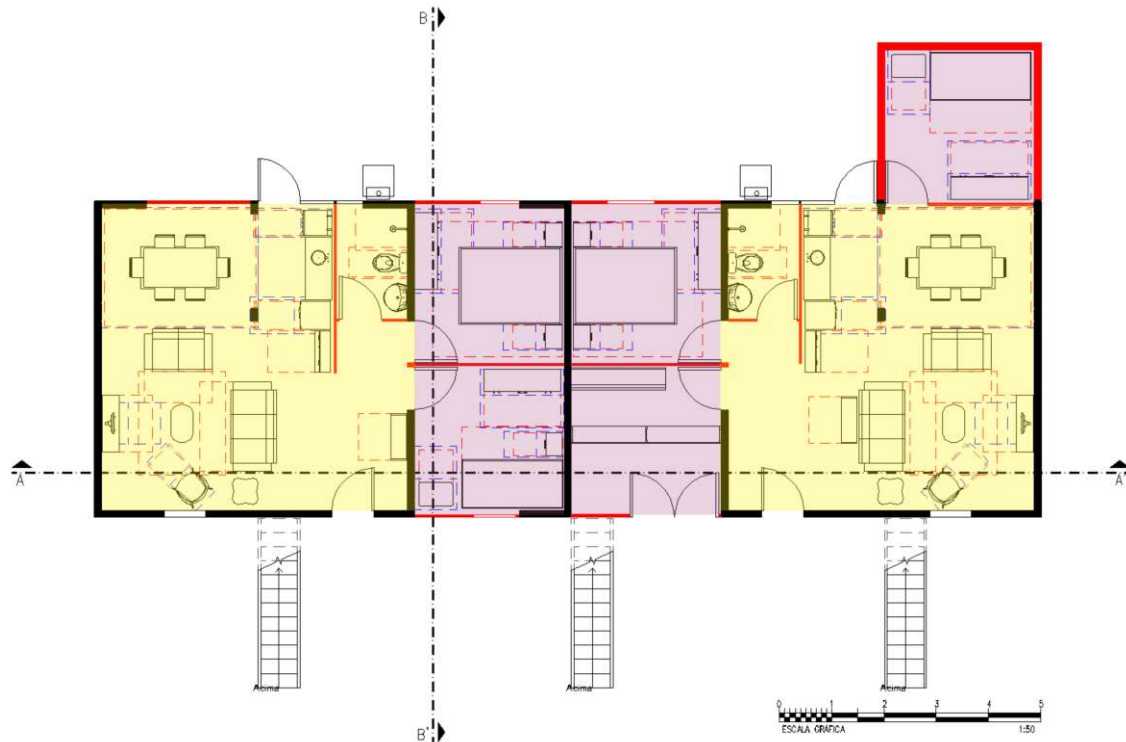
Planta do nível térreo com possíveis modificações geradas no modelo BIM -
